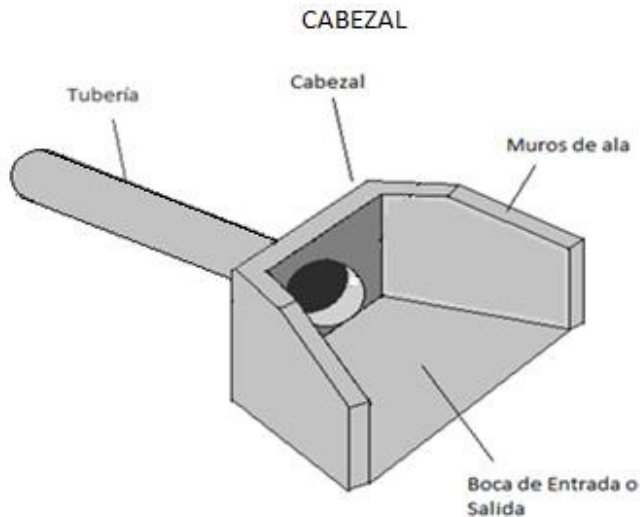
Alcantarilla Tipo de entrada (Cajón)
